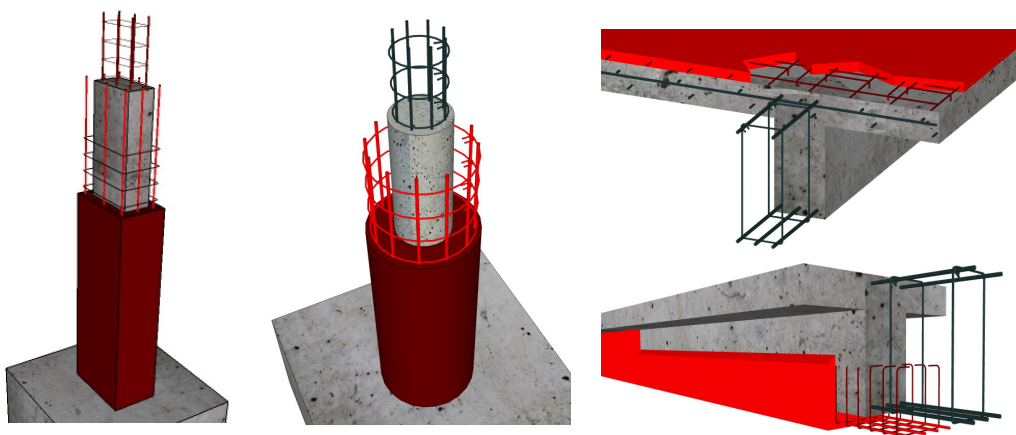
Pormenores do reforço com adição de betão e armaduras em pilares, lajes e vigas
